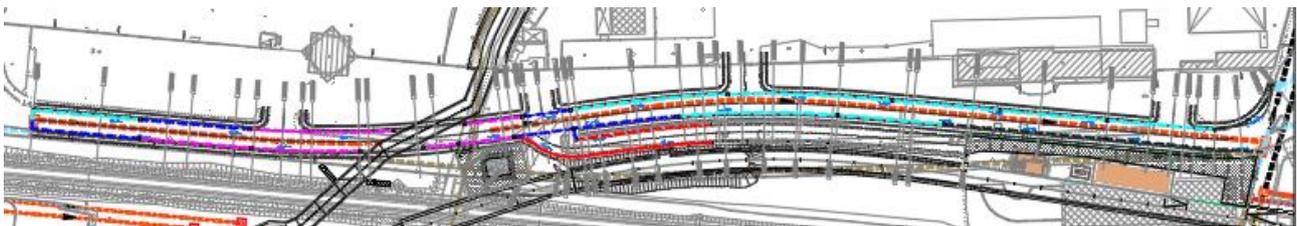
Stralcio planimetrico drenaggio viabilità NV02
